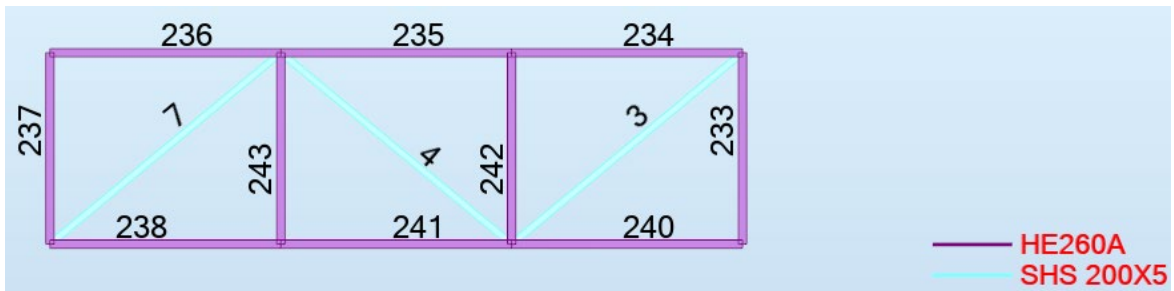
Planta da cobertura com os elementos estruturais numerados
